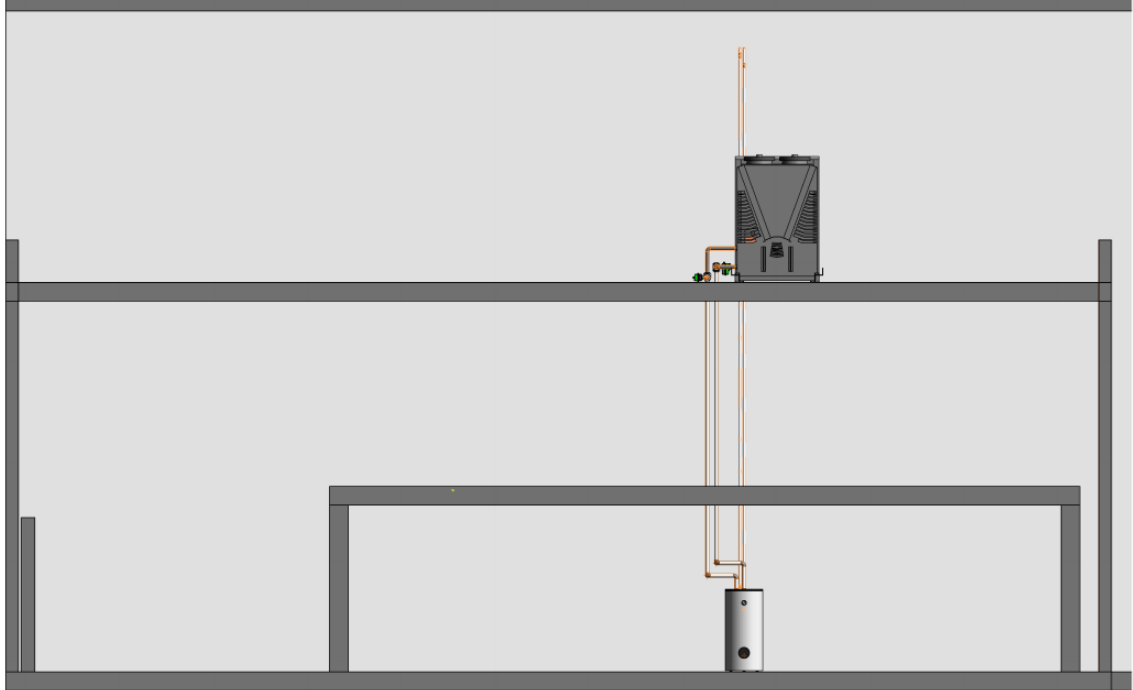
Corte da área técnica com tubagem de água para descongelação.
